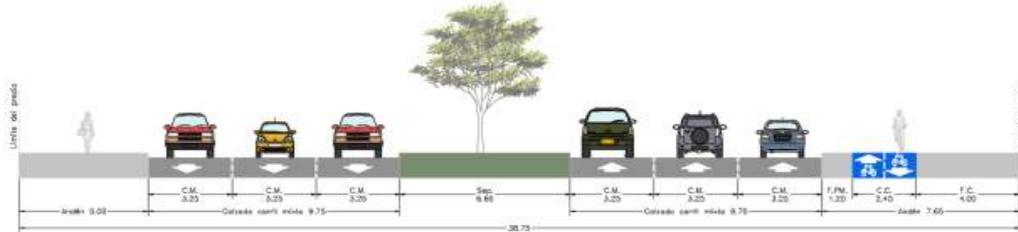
Sección Típica sobre la Av. Ciudad de Villavicencio entre la Troncal Cali y la Av. 1 de Mayo.
